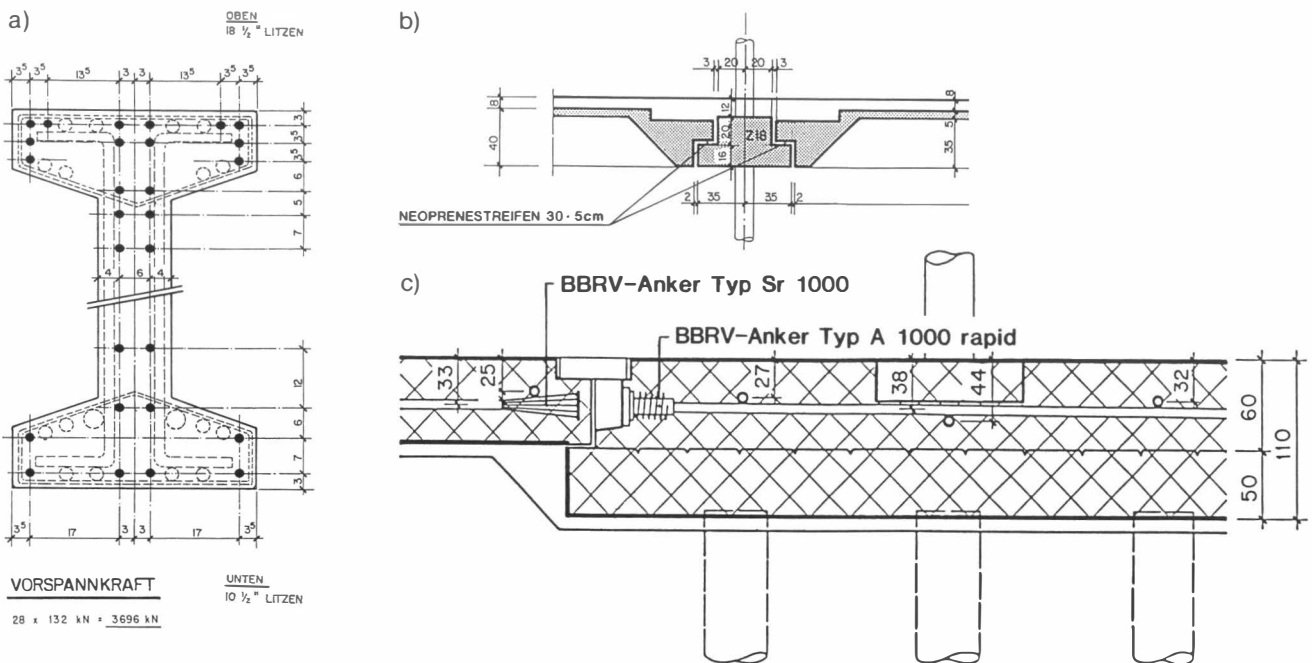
Details: a) Querschnitt des Hauptträgers, b) Geschossdecke, c) Bodenplatte - Détails: a) Coupe en travers de la poutre principale, b) Dalle sur un étage, c) Dalle du plancher - Détails: a) main girder crosscut, b) Storey slab, c) Floor slab
